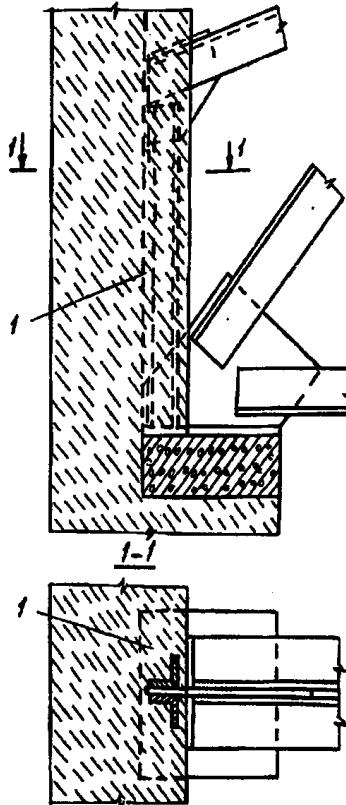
Неправильное опирание стальной фермы на кирпичную стену:
